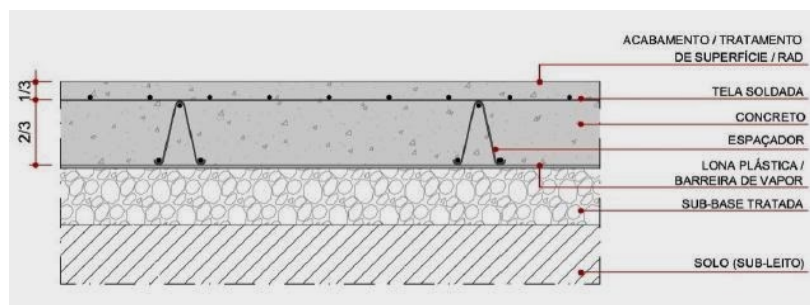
Seção de pavimento de concreto com armadura distribuída contínua
